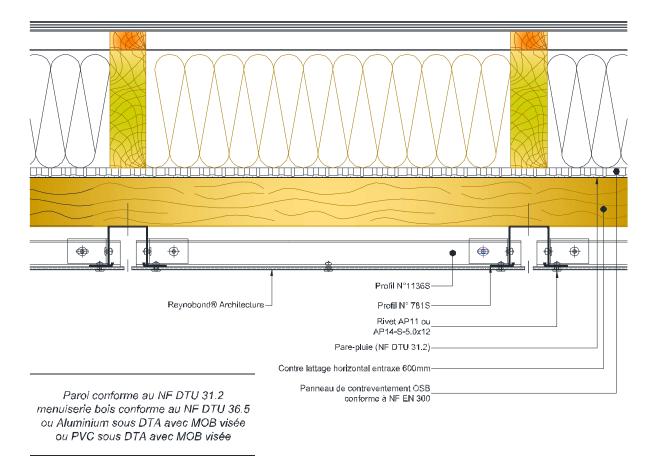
Joint vertical - Coupe horizontale – Système riveté RV 50 4c – Pose sur COB
